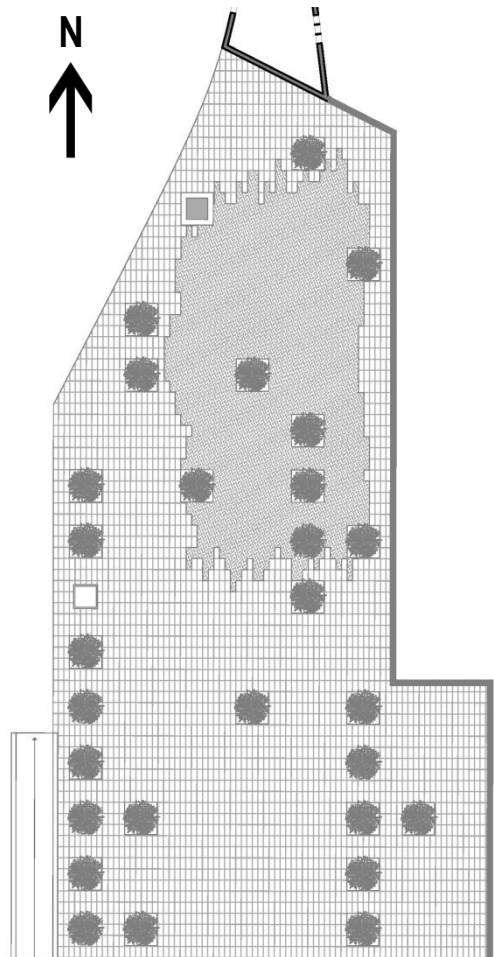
Planta do Terreiro, proposta de intervenção, Imagem do autor.
